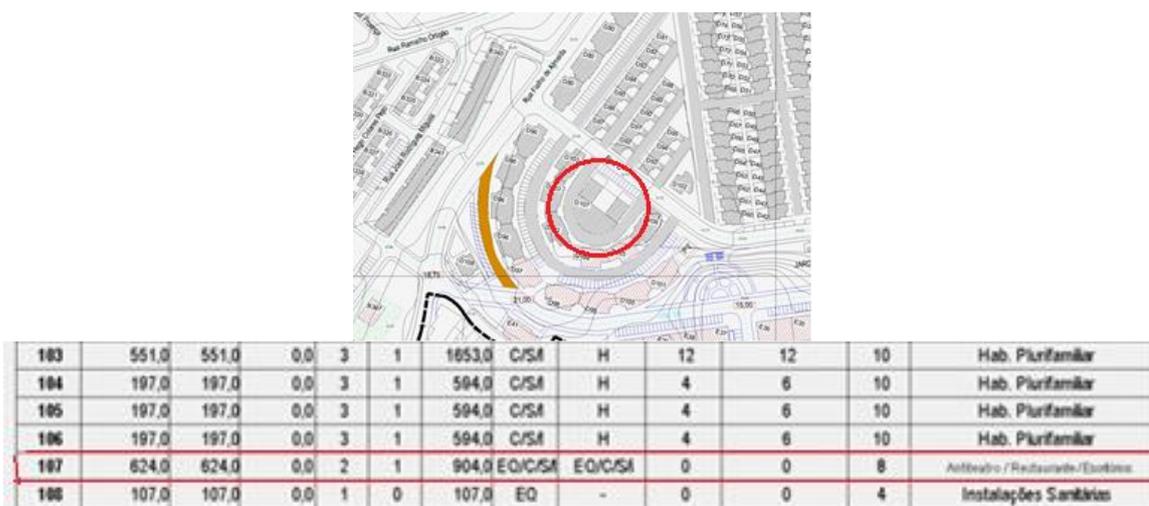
Extrato da Planta de Implantação e respetiva legenda.
